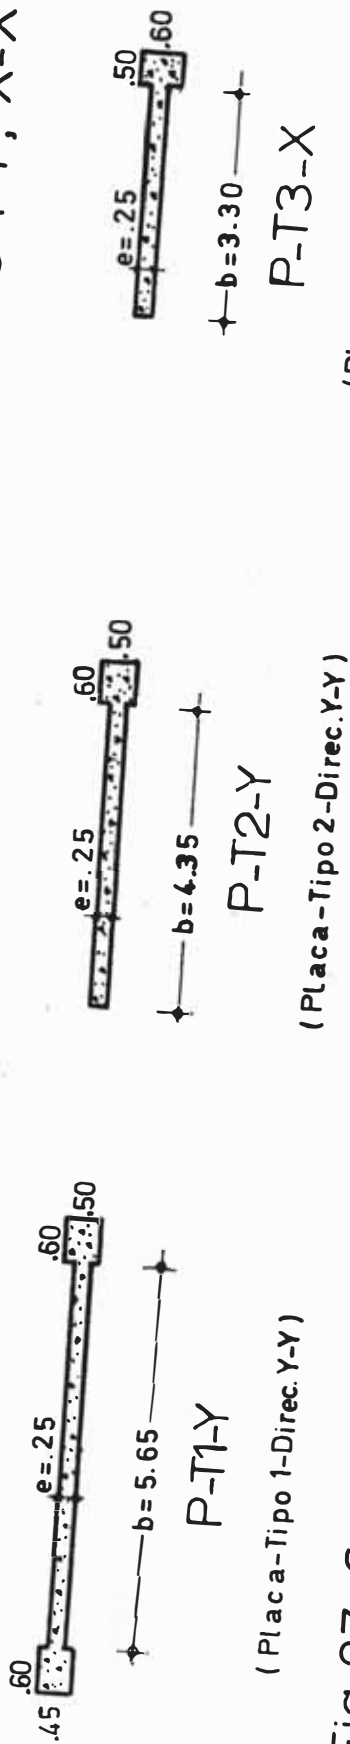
Sección recta de Placas de refuerzo. Dimension "b" varía ligeramente de un piso a otro.
